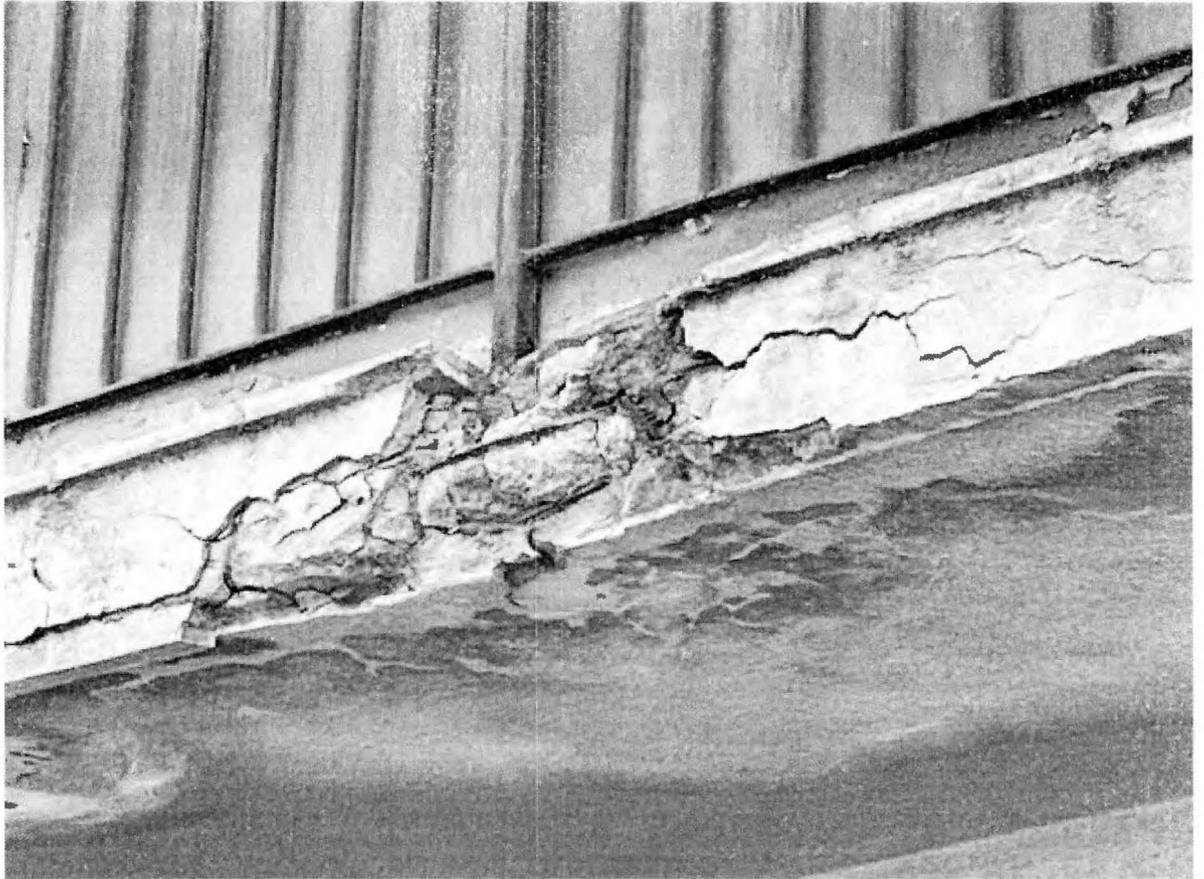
Desprendimiento y oxidación de acero refuerzo en losa de balcones fachada sur.
